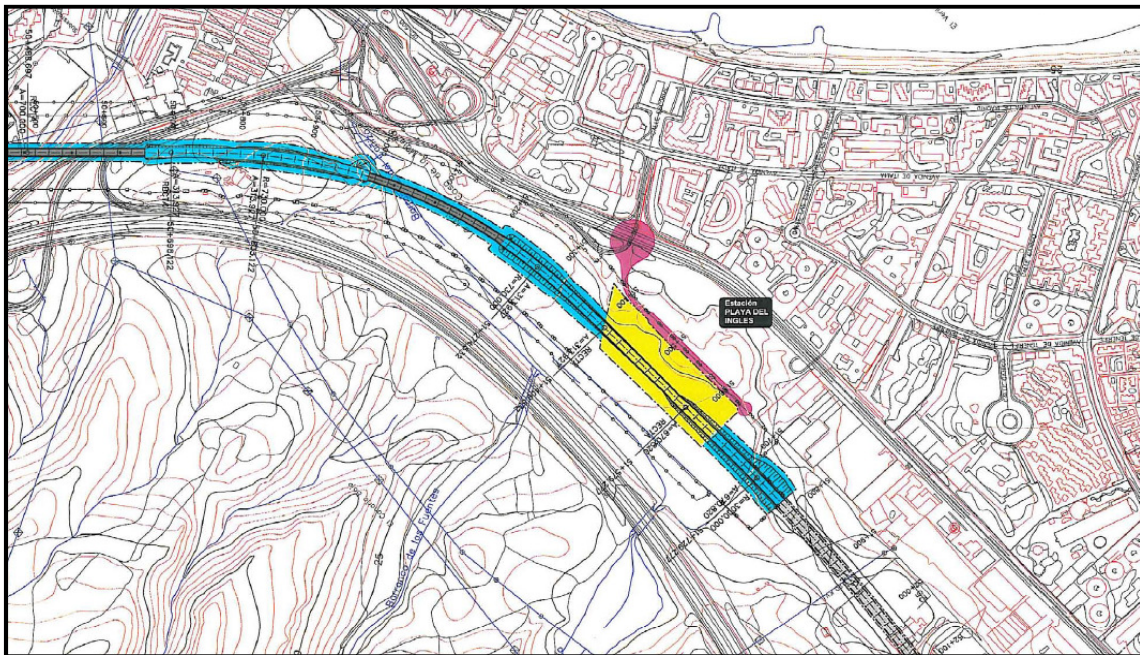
Extracto del Plano de Ordenación B.2.2 del PTE-21 vigente
